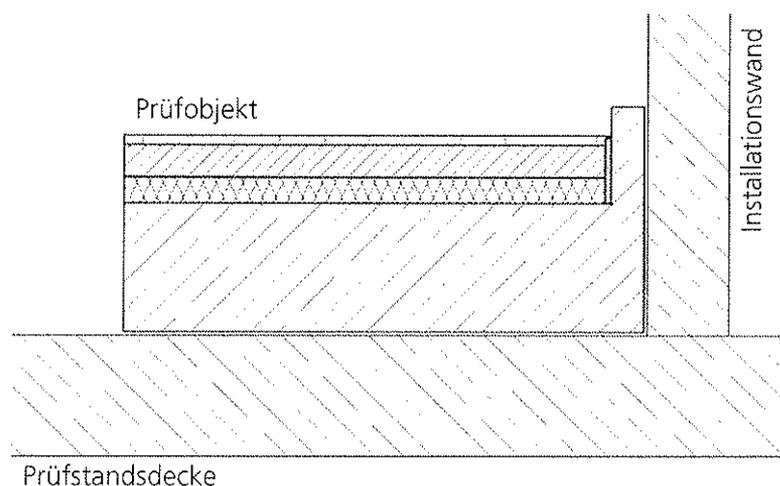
Schnittzeichnung des Prüfaufbaus im Installationsprüfstand P12 des IBP (ohne Maßstab).
